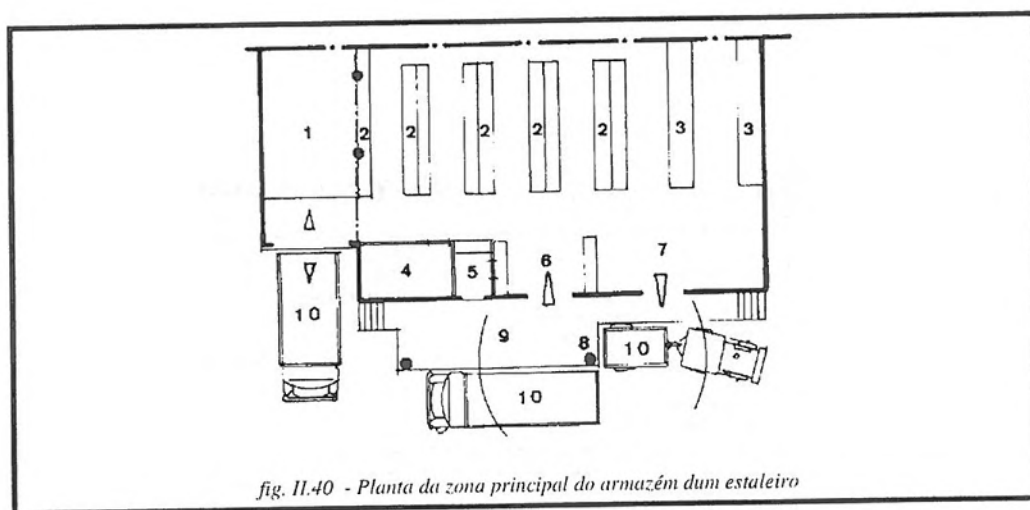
Planta da zona principal do armazém dum estaleiro
